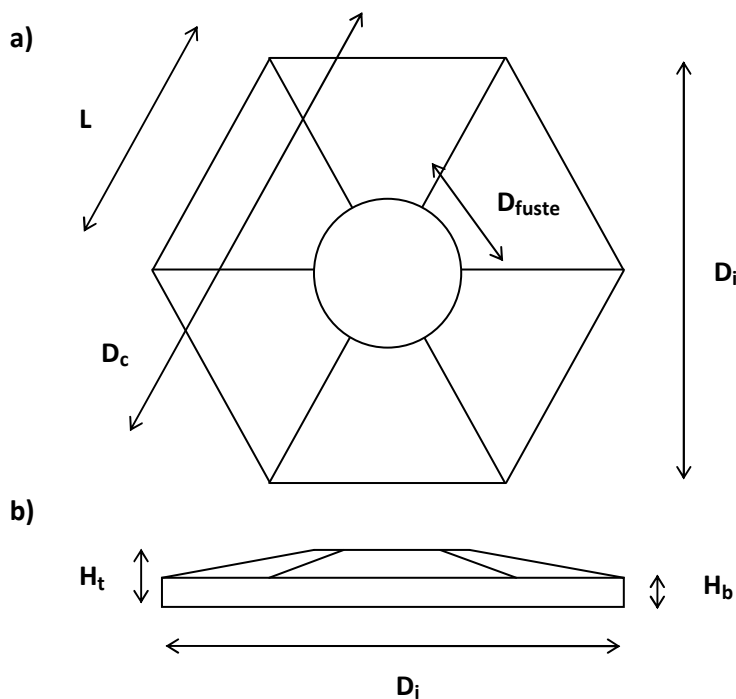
Zapata hexagonal: a) vista en planta, b) vista en alzado.
